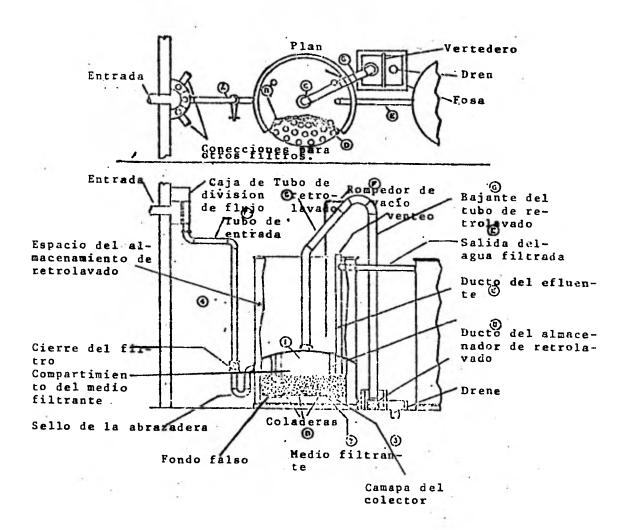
Filtro Automático de Gravedad sin válvulas.
